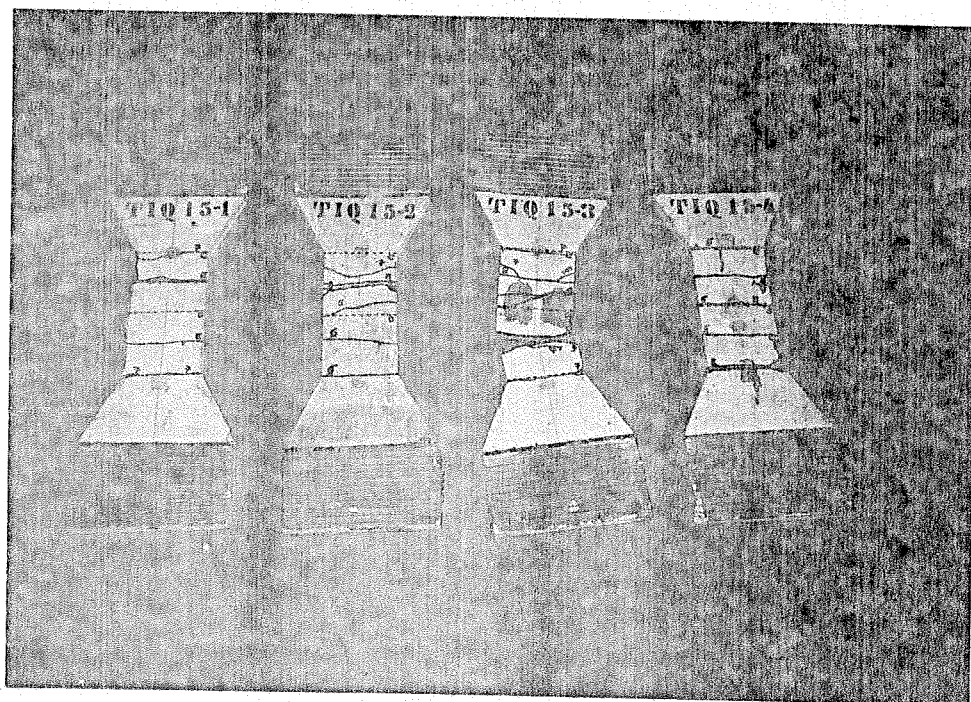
Fissuração final - Série TIQ15 (face 2 - regiões C e D)
